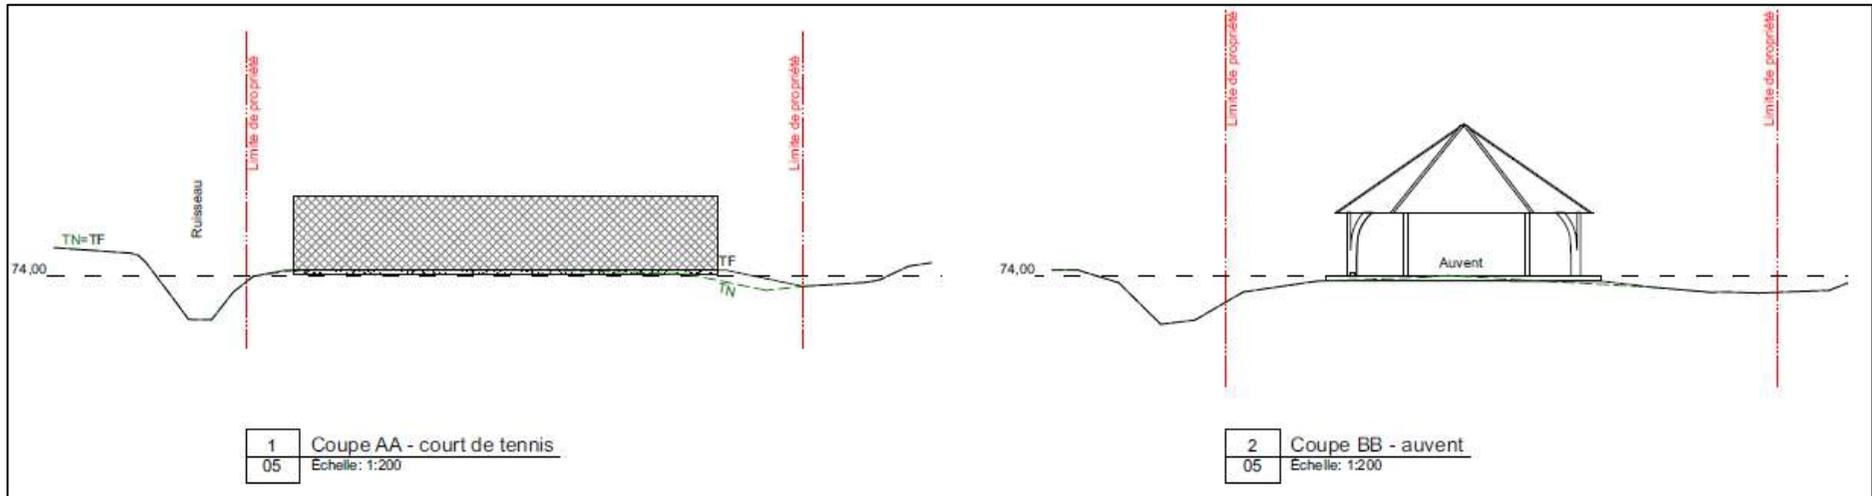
Plan en coupe du projet - zone B, SAS Architecture 3J
